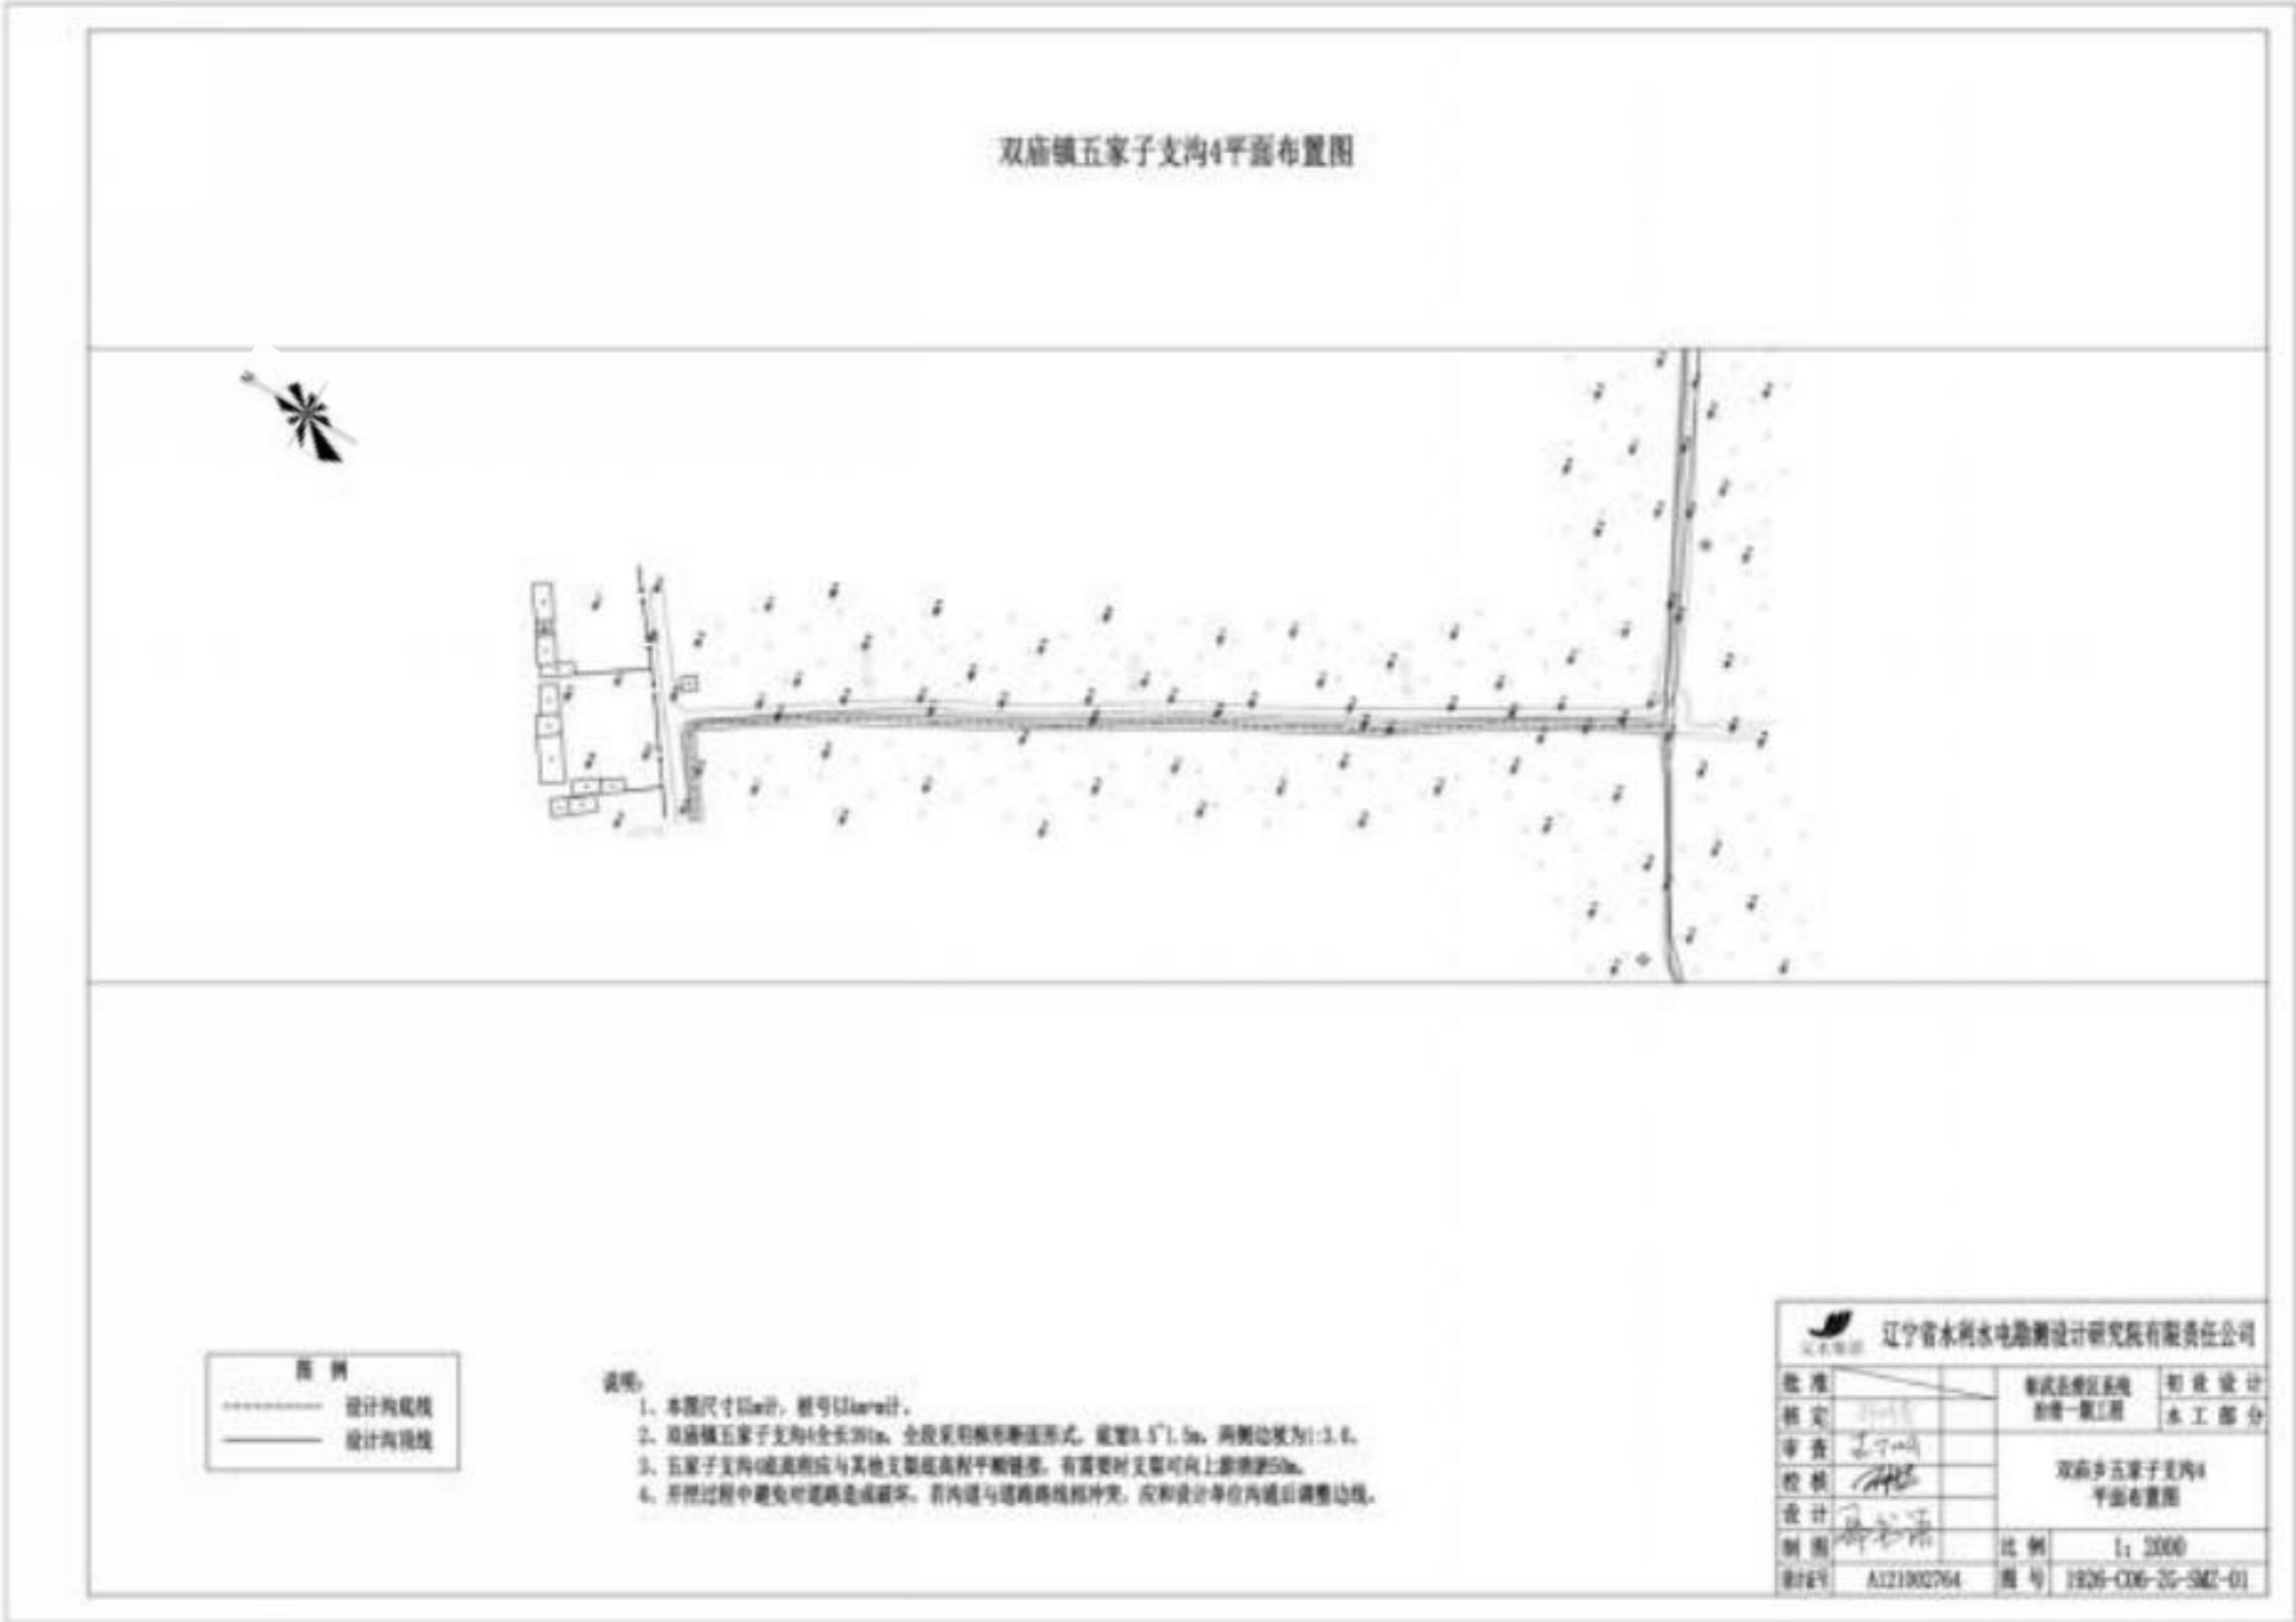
双庙镇五家子支沟 4 平面布置图
